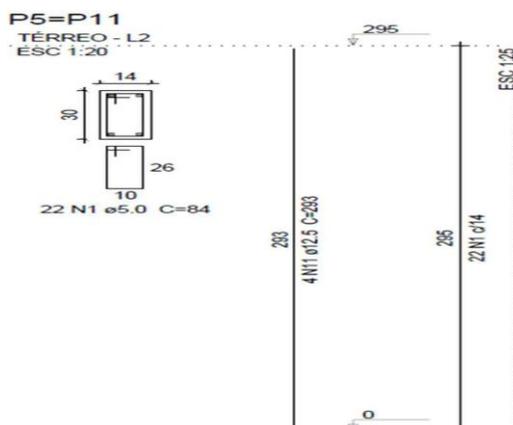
Seção de aço dos pilares e detalhes da armadura long/trans
